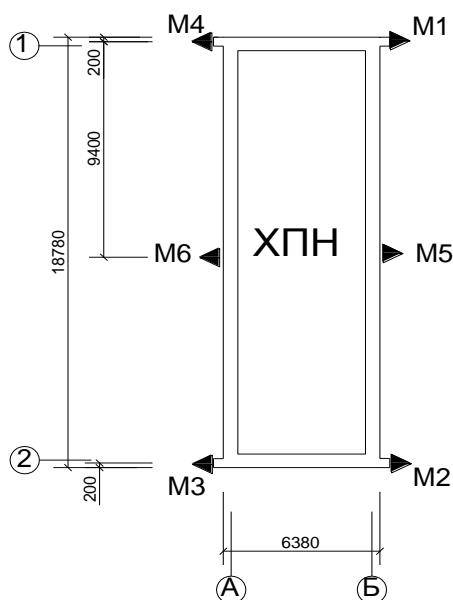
Схема расположения осадочных марок на фундаментах здания ХПН
